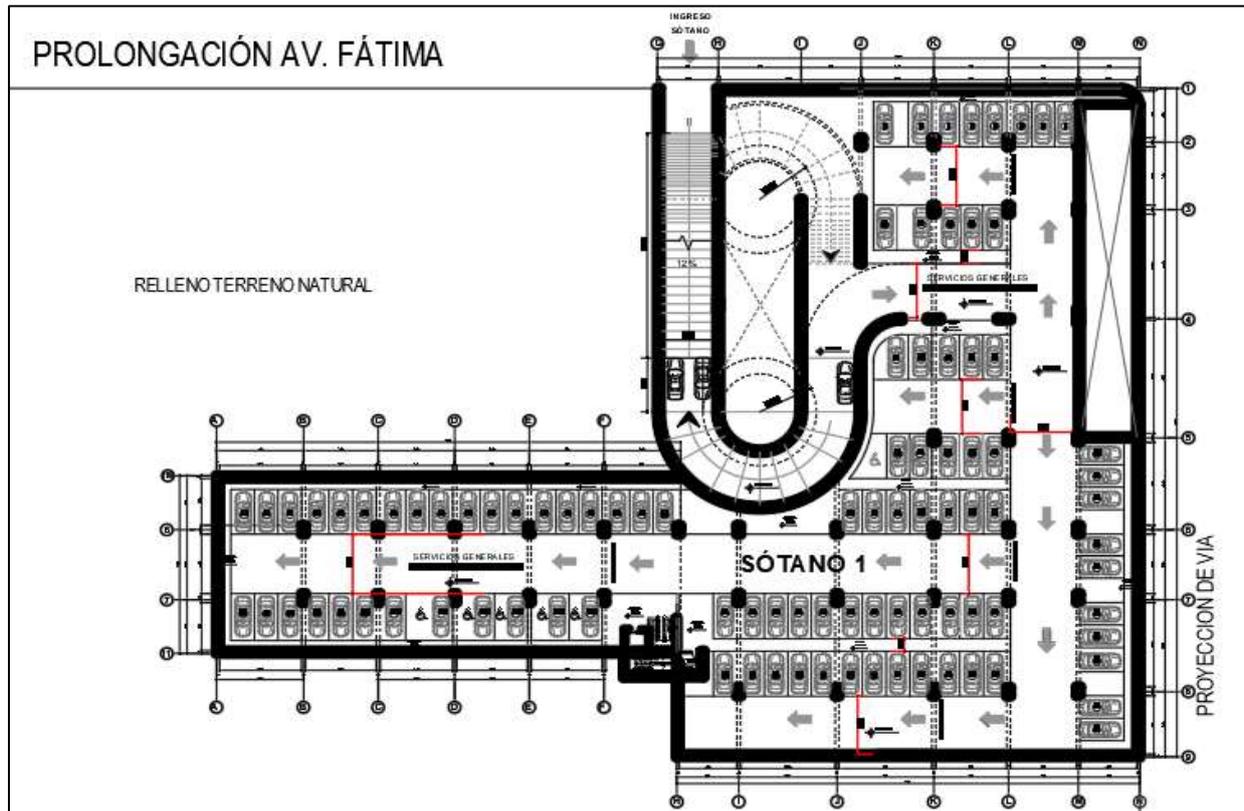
Vista plano de sótano. FUENTE: Elaboración propia.
